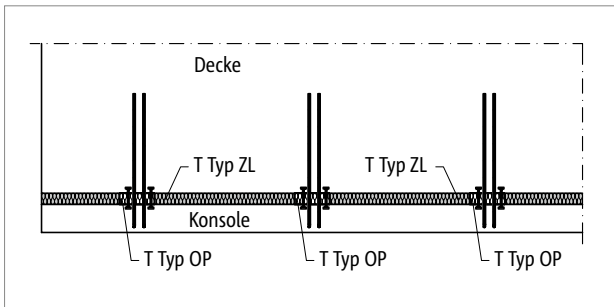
Schöck Isokorb® T Typ OP, ZL: Konsole
